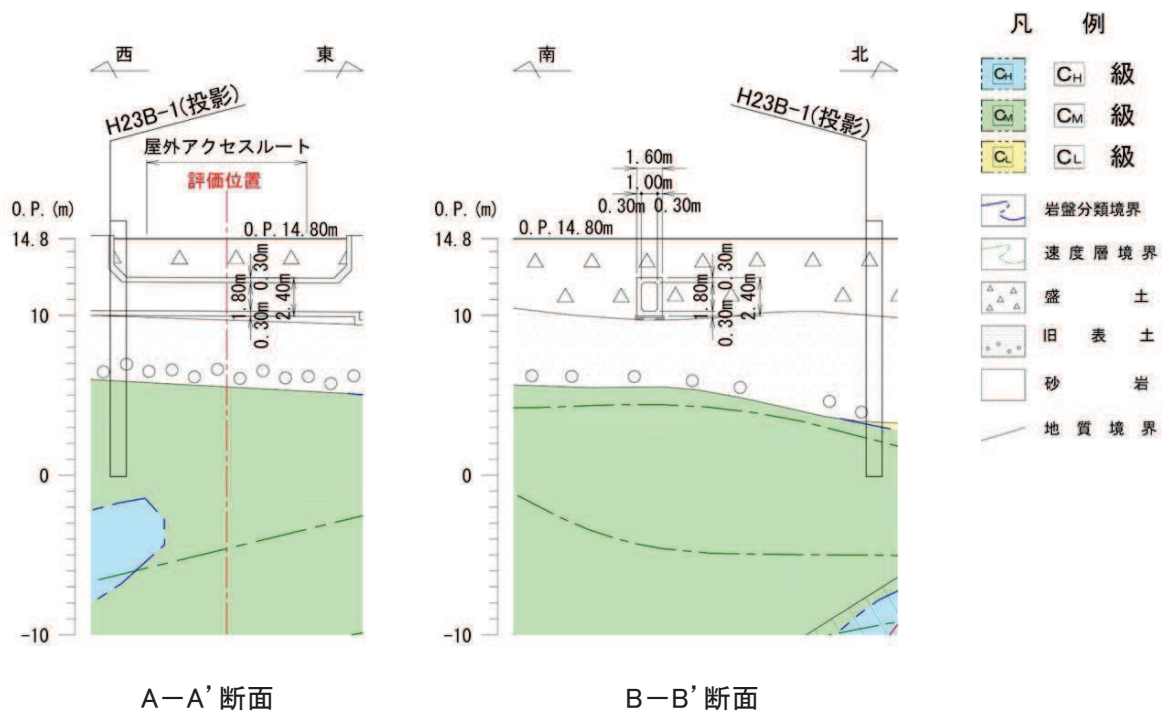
地質断面図 (A-A' 断面, B-B' 断面)
